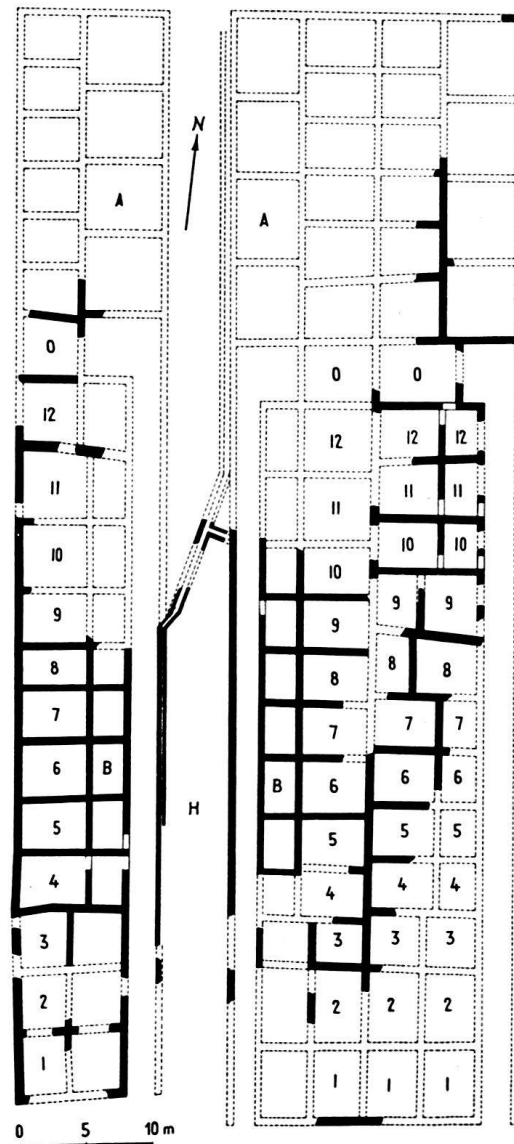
Die Kasernen-Steinbauten, ergänzter Grundriß
